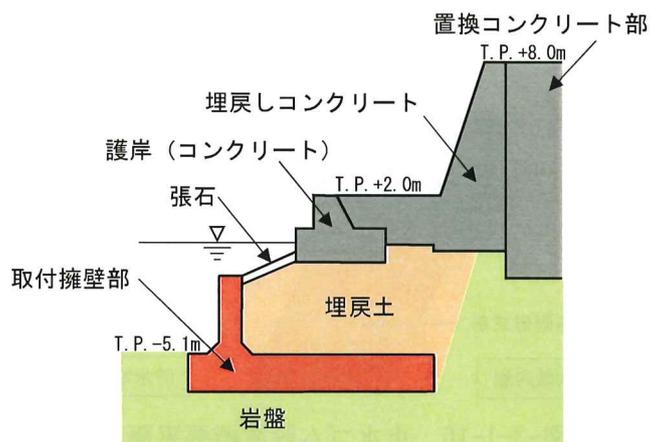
貯水堰断面図 (②-②断面) (取付擁壁部)
